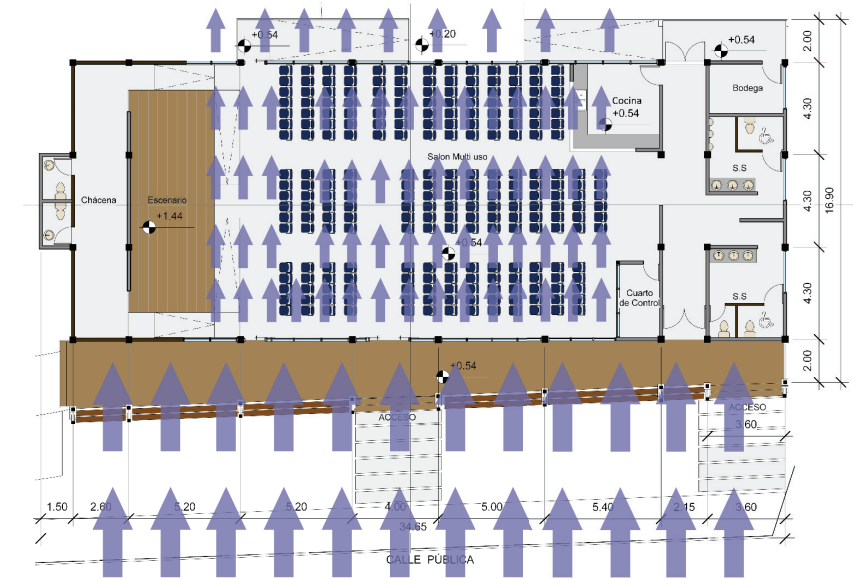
TRATAMIENTO CLIMÁTICO VIENTOS PLANTA
